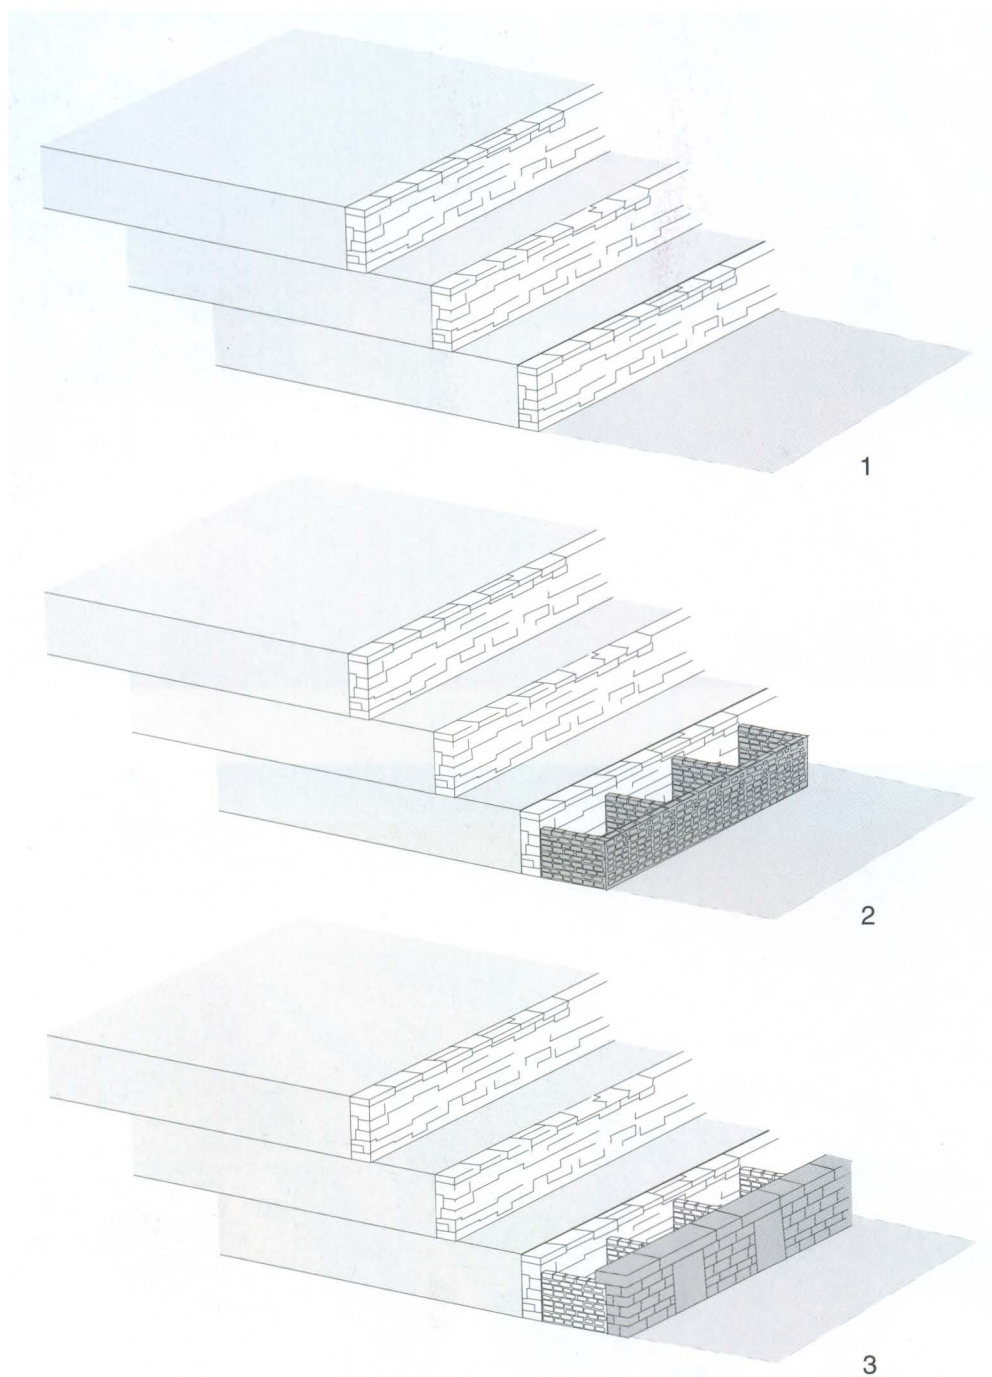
Técnicas constructivas de la Pirámide de Akapana. 1. Muros de contención y el relleno de arcilla y adobes; 2. Adición de las cámaras de construcción; 3. Adición de la fachada.
